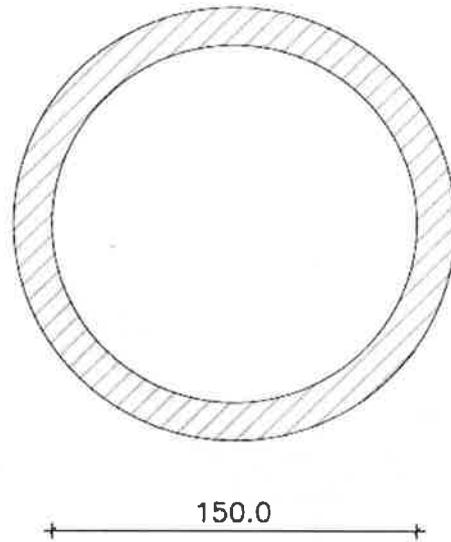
Inalveazione IN02 – tombino di attraversamento del piazzale. Sezione tipologica
